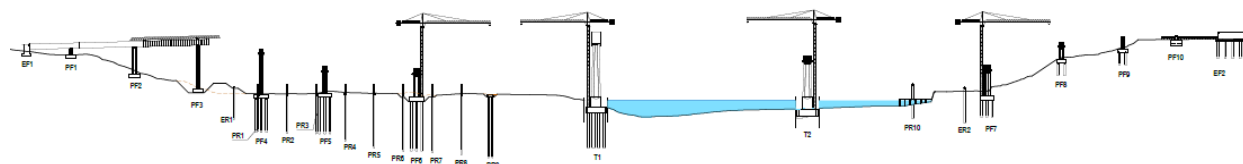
Faseamento construtivo – Etapa 2 de 6
